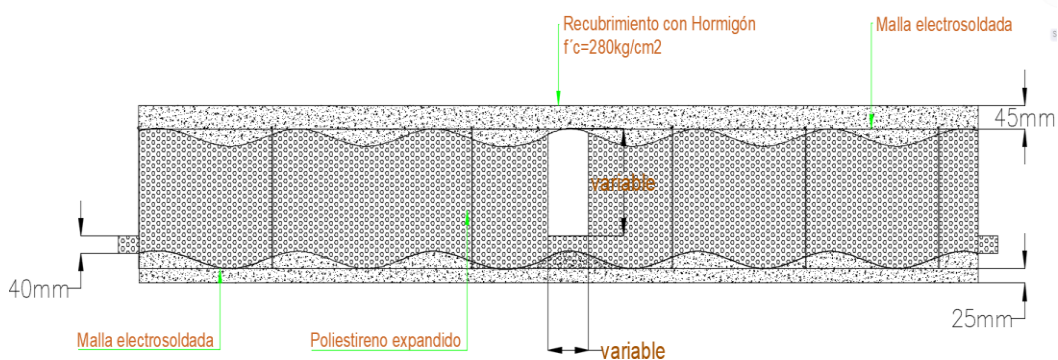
Sección típica Panel Losa estructural 2 nervaduras
